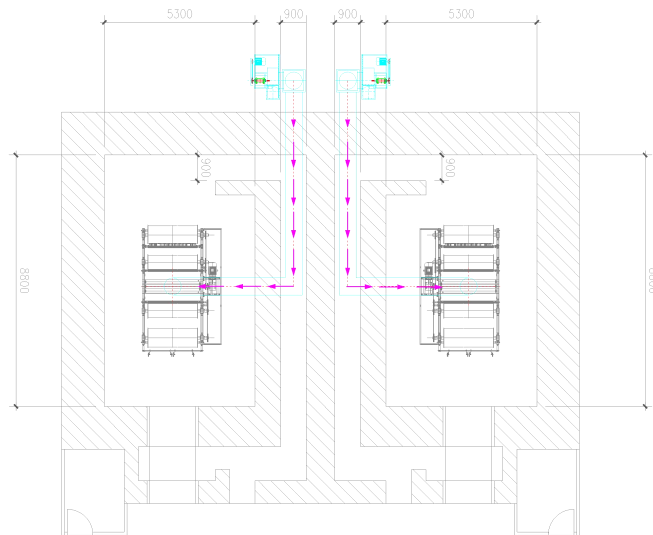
本项目加速器机房通风管道布设示意图（平面图）
